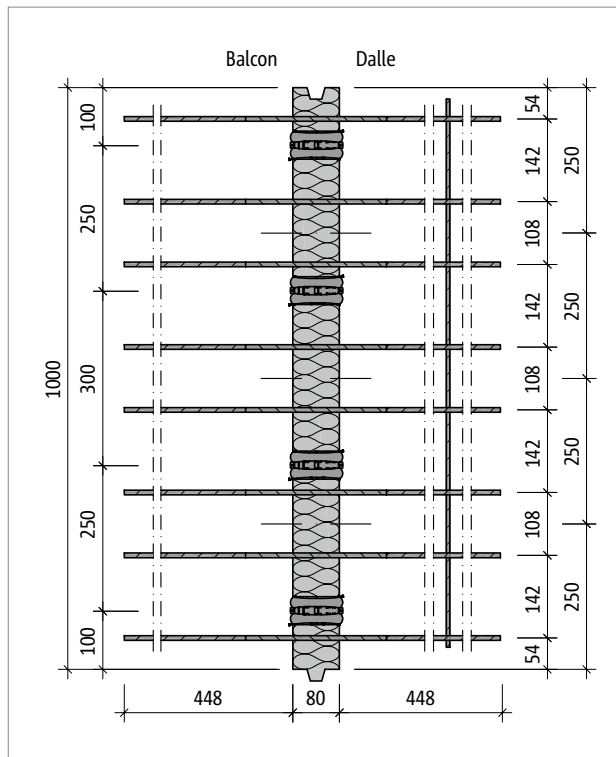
Schöck Isokorb® T type Q-E-V4 : plan de base du produit
